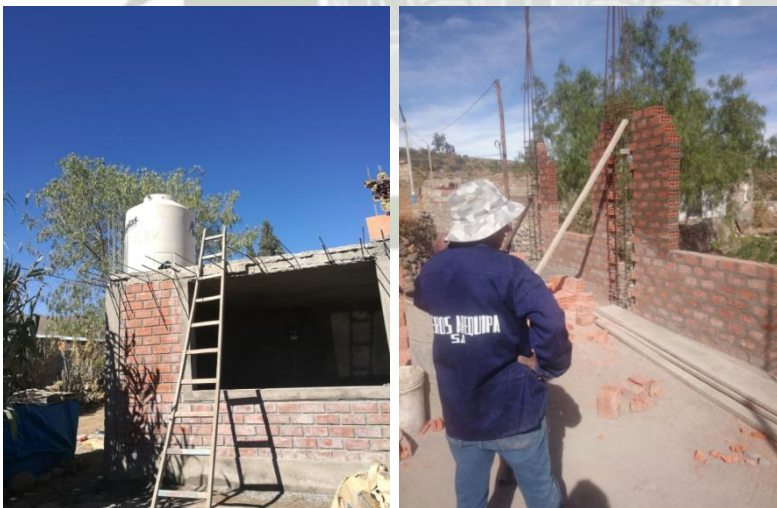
Acero expuesto en viviendas SA-03 (losa) y S-01 (Columna)
